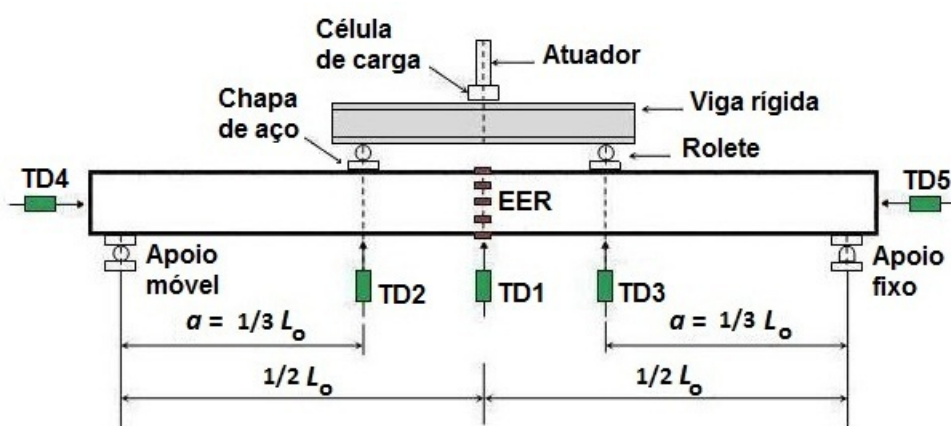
Ensaio de flexão: esquema para as vigas mistas sem laje colaborante (protótipos FLX-VM-SL)
